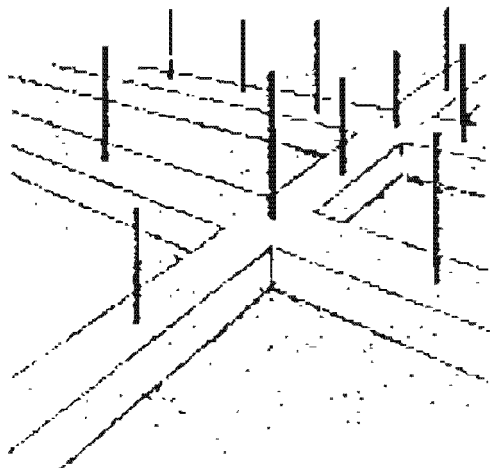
Anclaje de refuerzos verticales desde la cimentación o cadena de desplante
